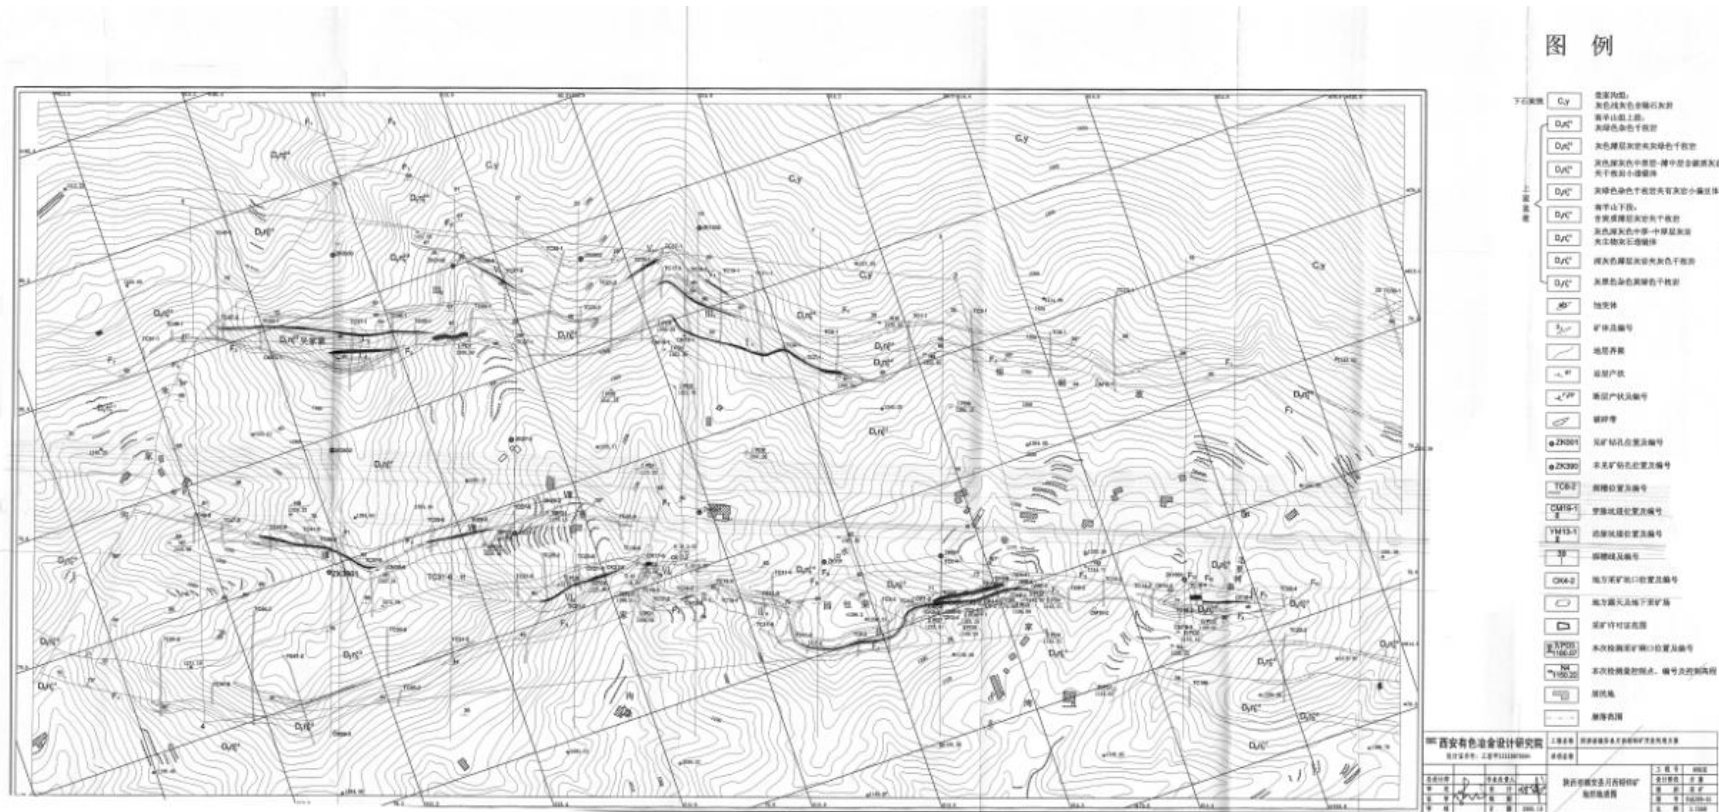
镇安县月西铅锌矿矿区总平面布置图（大图另打印）
